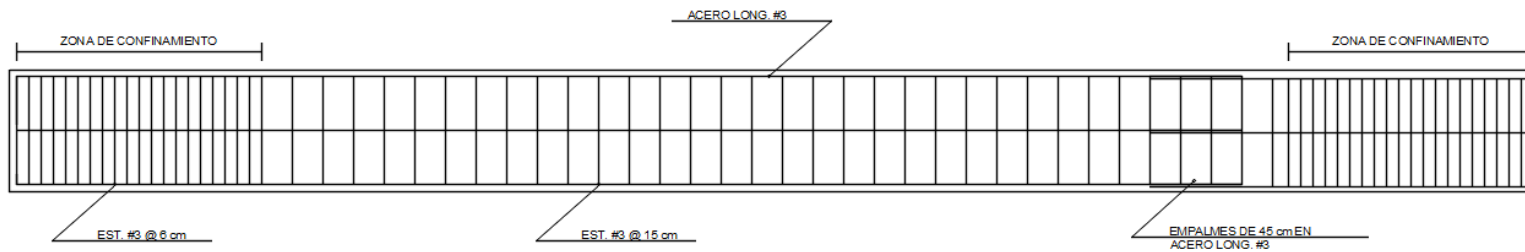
Plano de taller para solera SC - 2, sección longitudinal
